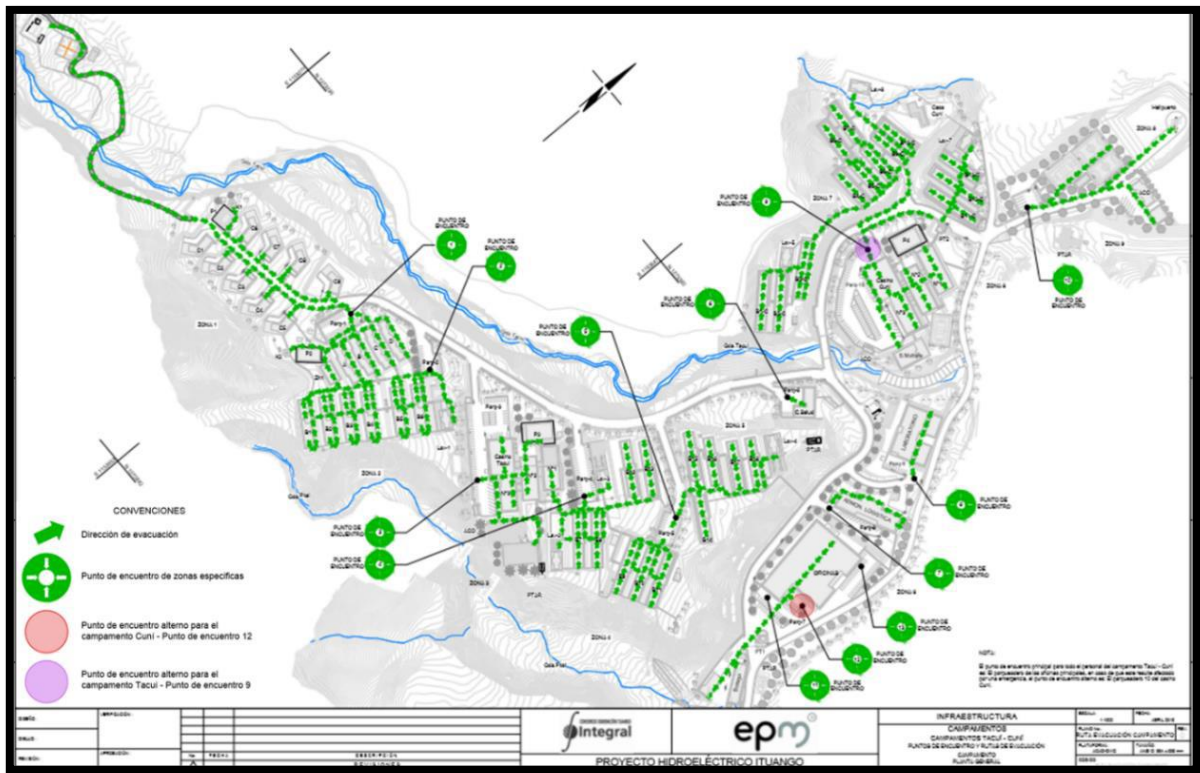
Disposición de edificaciones planta general campamento Tacuí Cuní.
